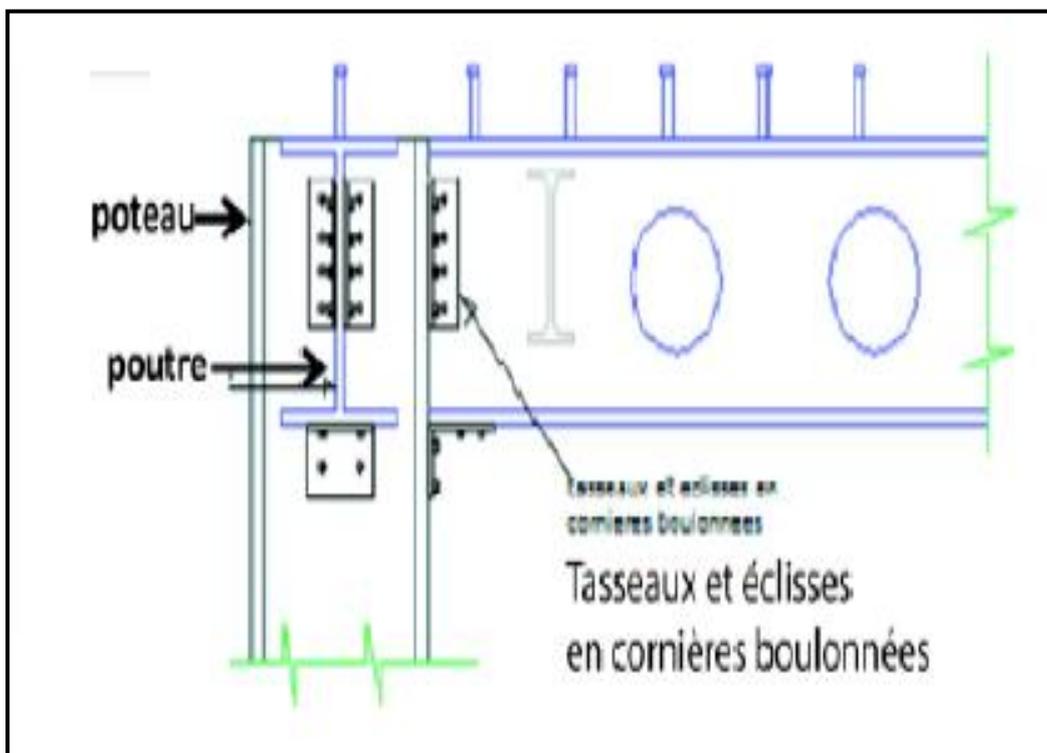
assemblage poteau- poutre /source : mémoire Boussakou L. ET Chenna A. Algiers' convention centre au Hamma, UMMTO, 2018.
